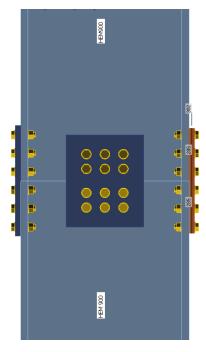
Assemblage poteau (HEM 900- HEM900).
